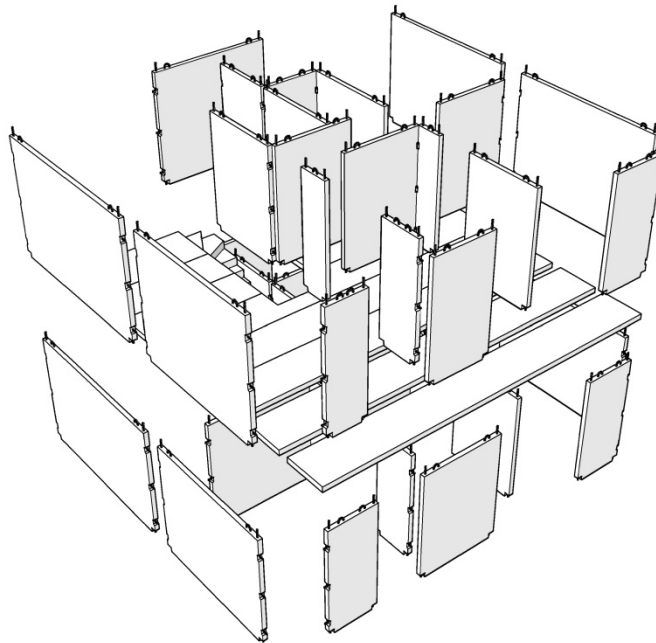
Estructura desmontable de SAYAB basada en paneles prefabricados de hormigón armado (Proyecto de Luis de Garrido)
